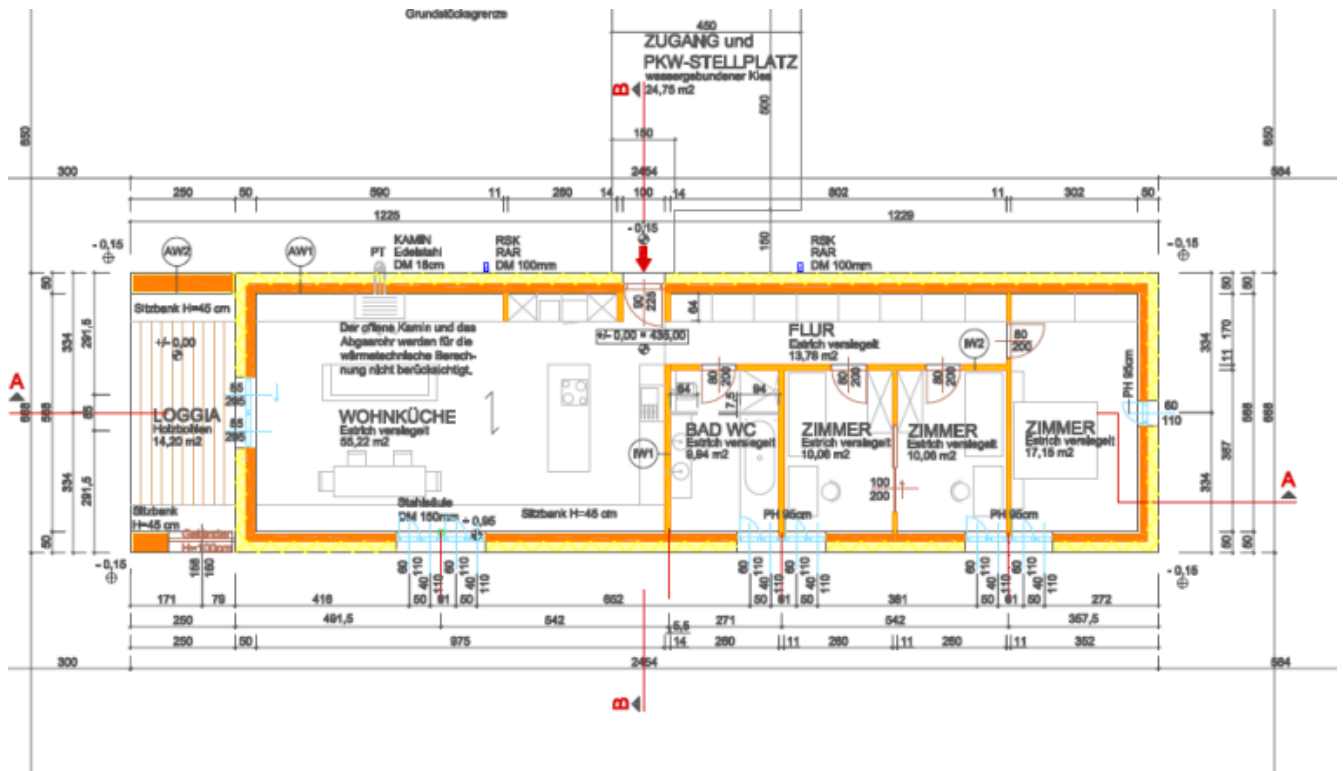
Grundriss Modellgebäude in massiver Bauform mit minimalen Fensterflächen lt. Bauordnung
